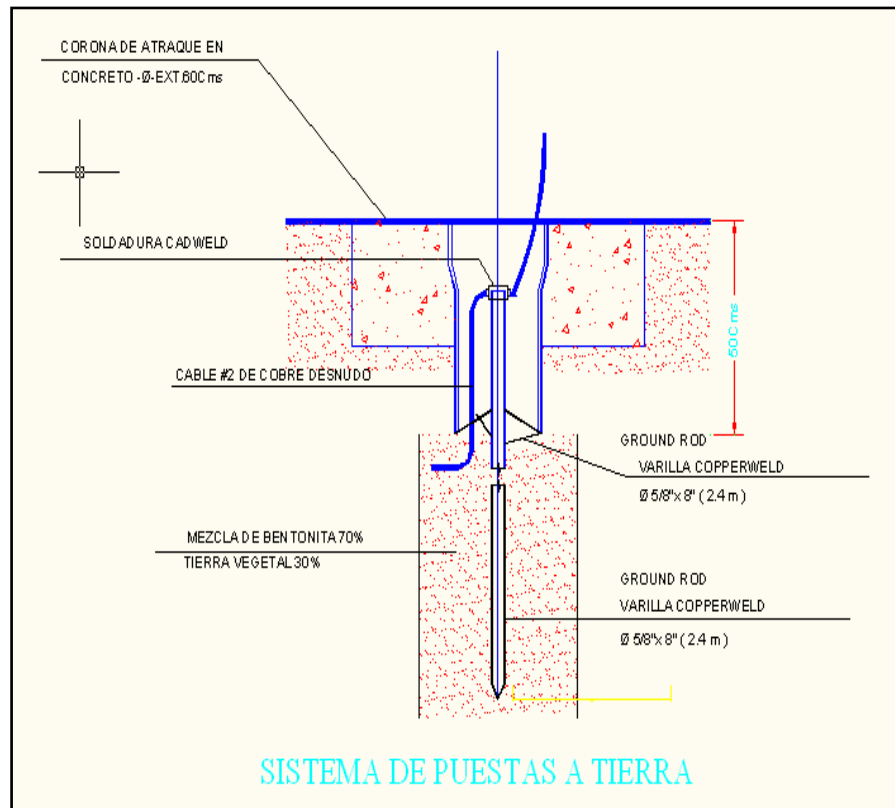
Detalle conexionado de Sistema de puesta a tierra. Soldadura Varilla – Cable.
